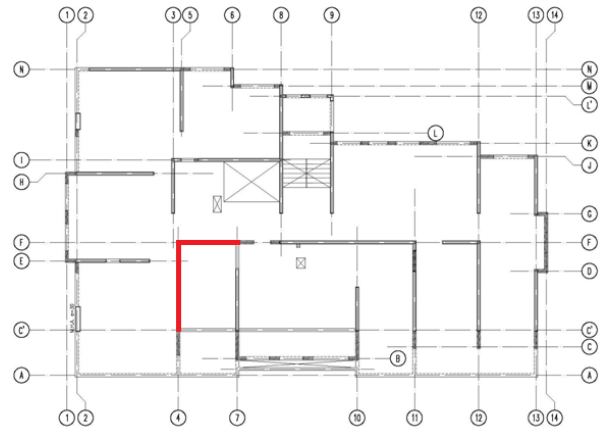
Ubicación Muros Eje 4 y Eje 7, Planta Piso 1
